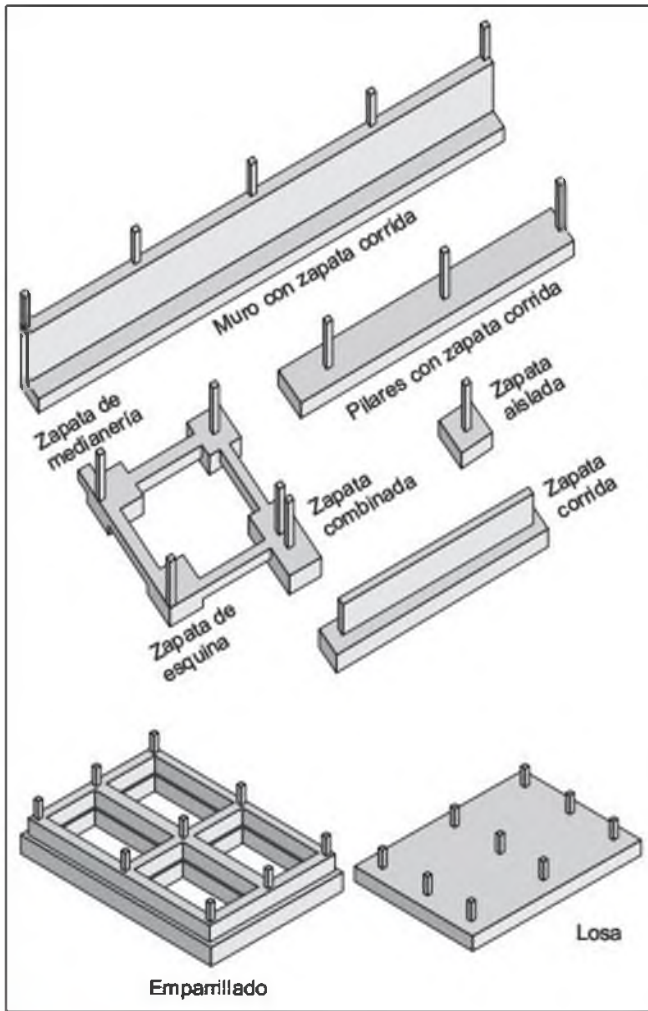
Tipos de cimentación directa (Calavera, 1987).
